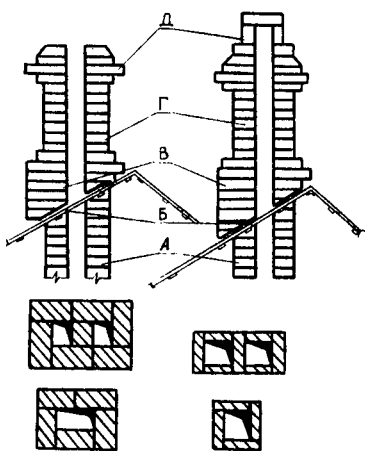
Устройство дымовой трубы: А — ствол; Б — выдра (углубление от течи); В — цоколь; Г — шейка; Д — карниз и колпак
